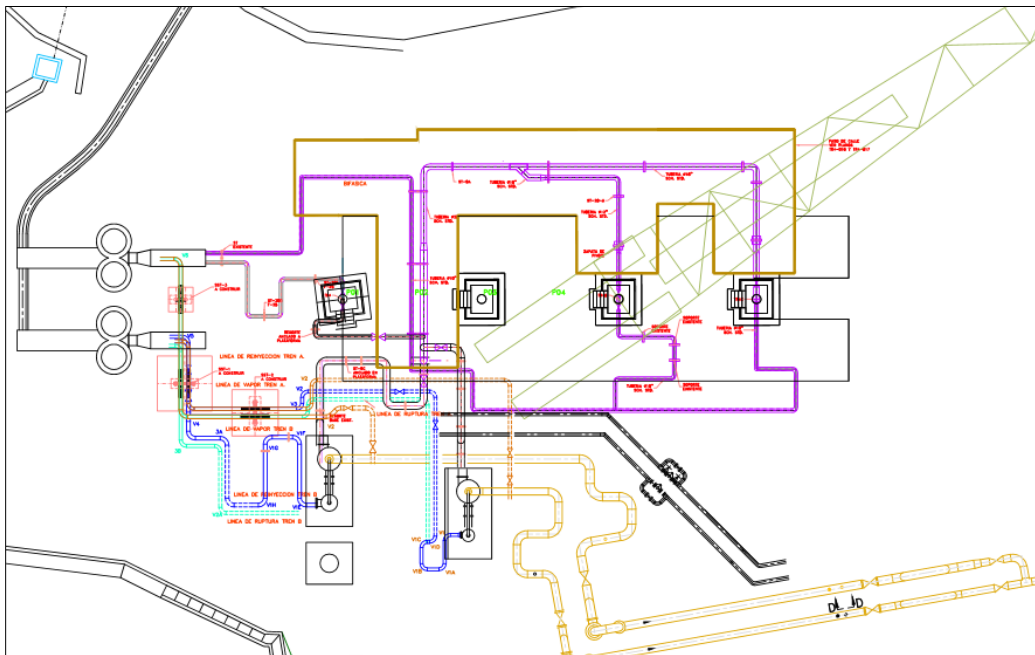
Vista en planta de nueva distribución de tubería subterránea.
